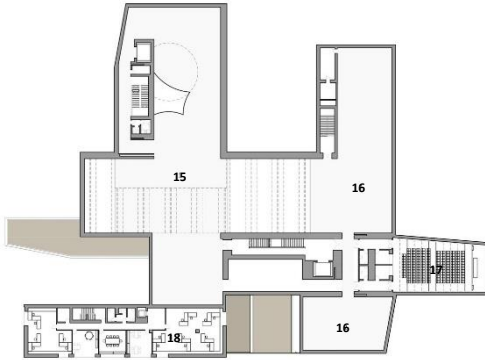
Planta de primer nivel arquitectónica del conjunto MUSEO IBERO. Santibañez, D. (12 de septiembre de 2020). ArchDaily.
